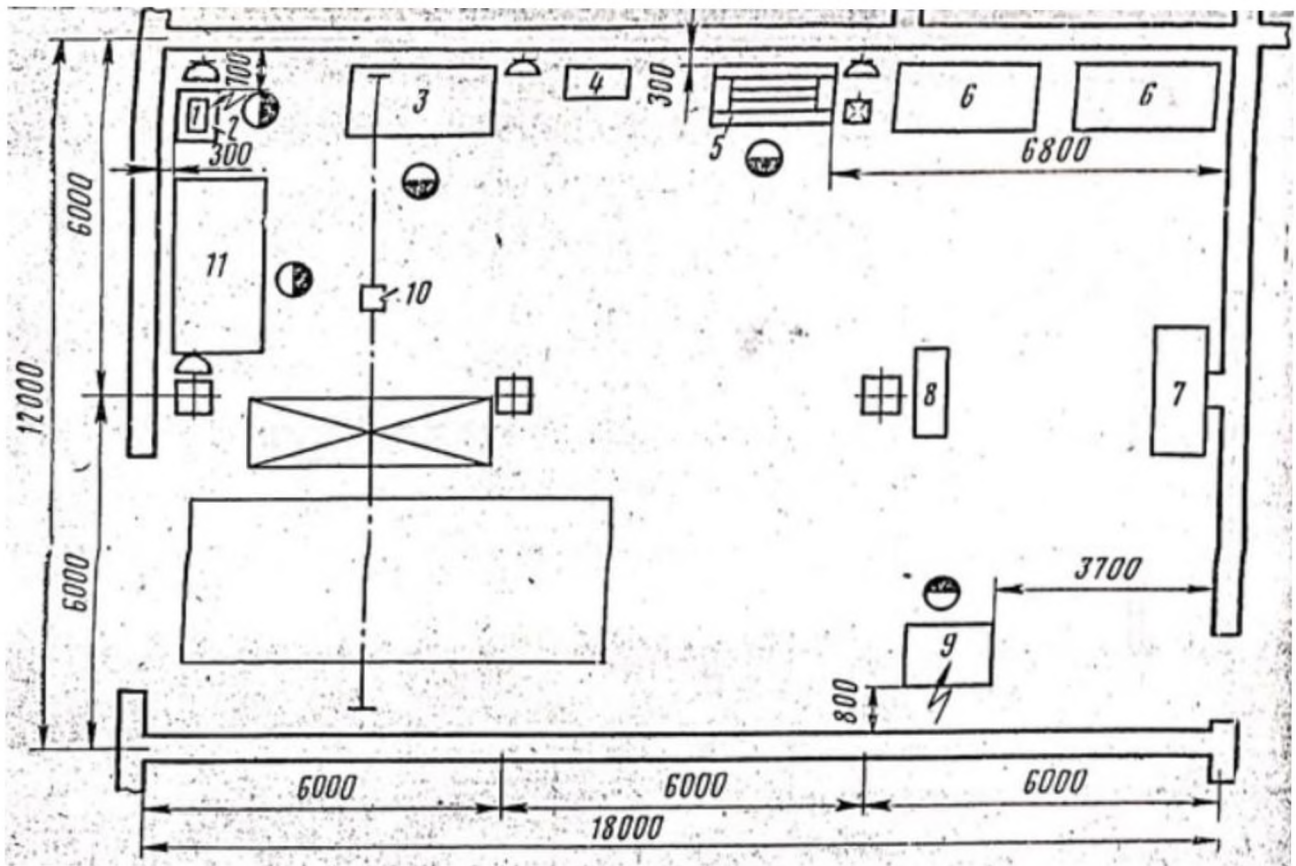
Планировка деревообрабатывающего и обойного цеха по типовому проекту СТО на 1200 грузовых автомобилей (Гипропромсельстрой):
